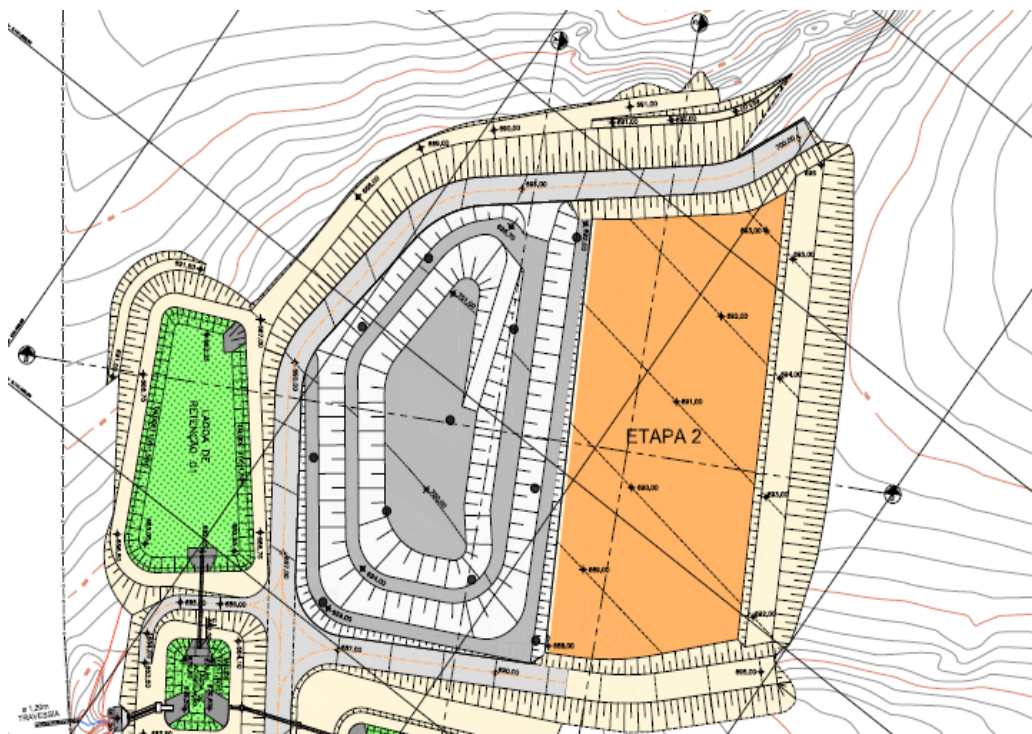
Implantação da Etapa 2 – Planta de Regularização da Base
